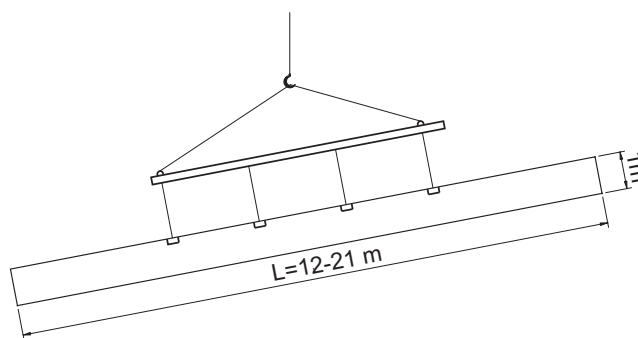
Использование поперечной балки при укладке панелей длиной свыше 12 м.
